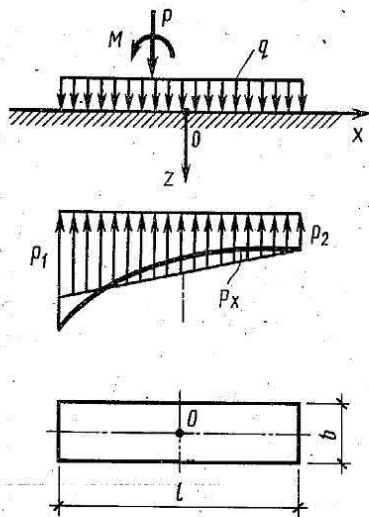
Предварительный подбор сечения фундаментной балки
